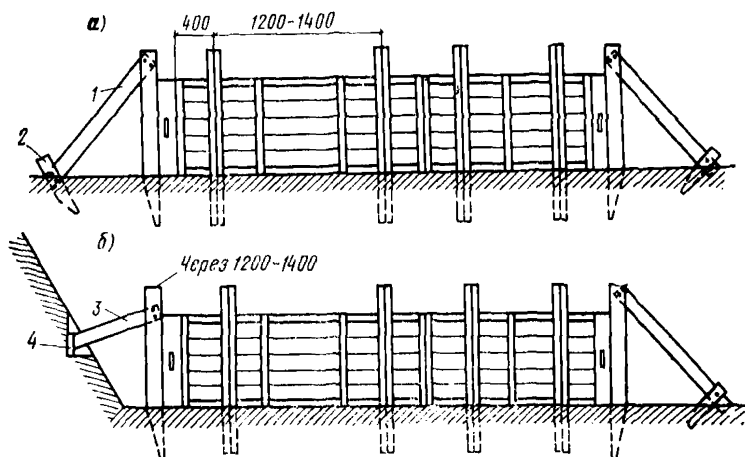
Способы крепления деревянной опалубки нижней ступени фундамента
